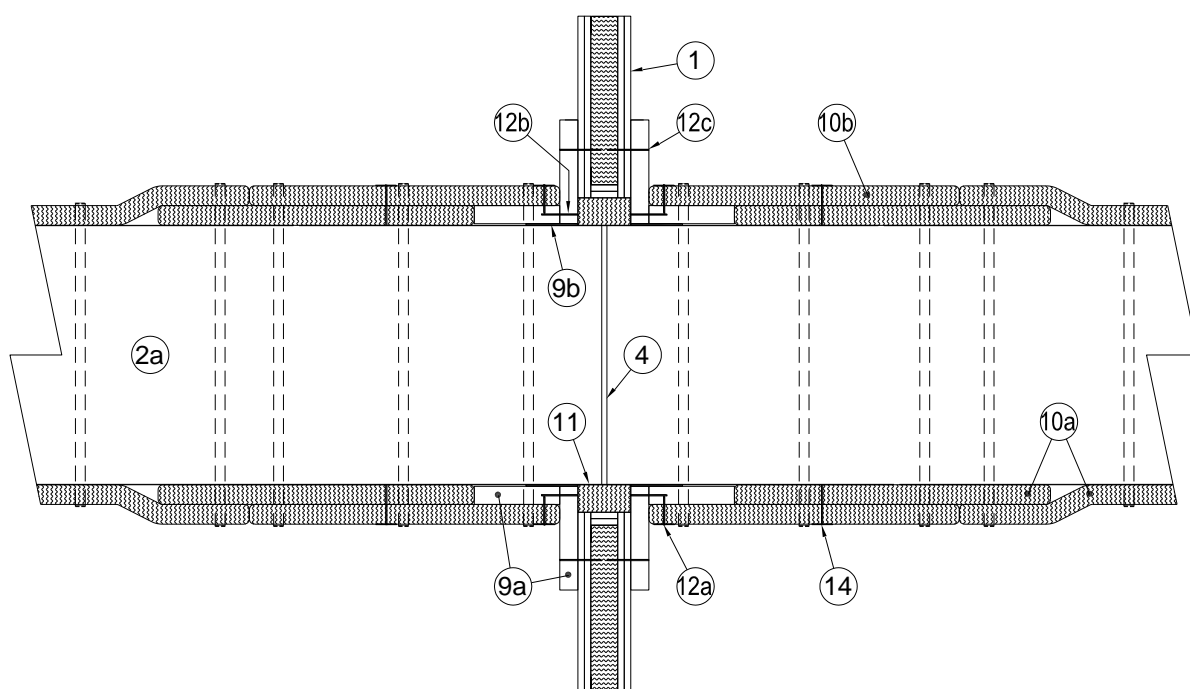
Typowy widok z boku - zamontowany zespół poziomy
